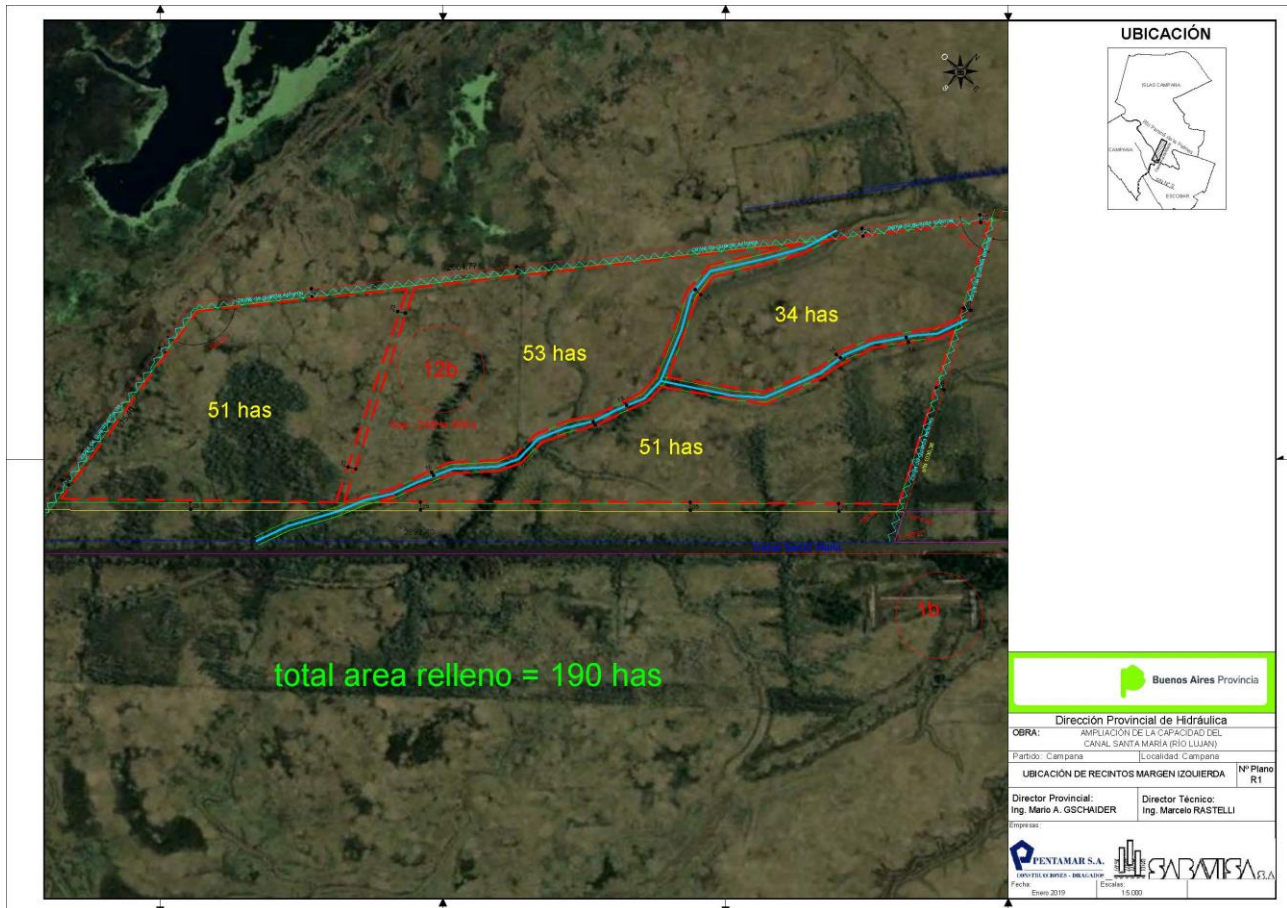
Detalle de los recintos a construir sobre parcela 12 B expropiada.
